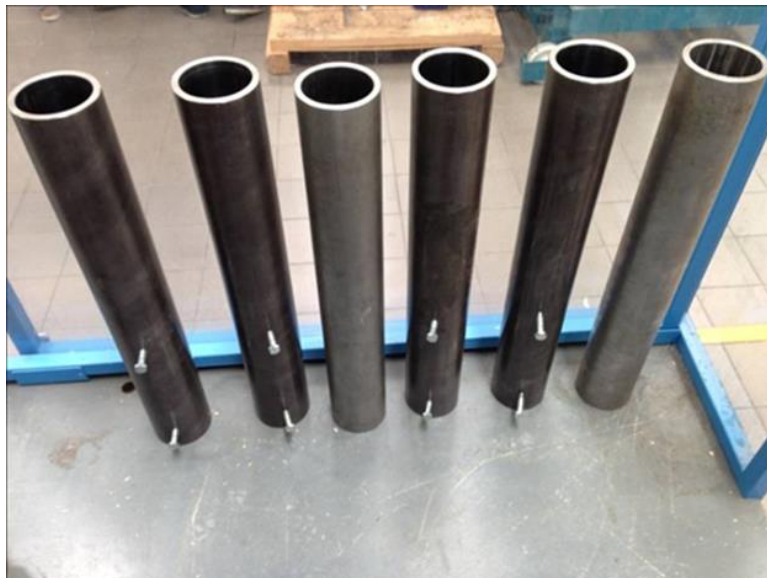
Dispositif utilisé pour la fabrication des éprouvettes de béton de chanvre.
